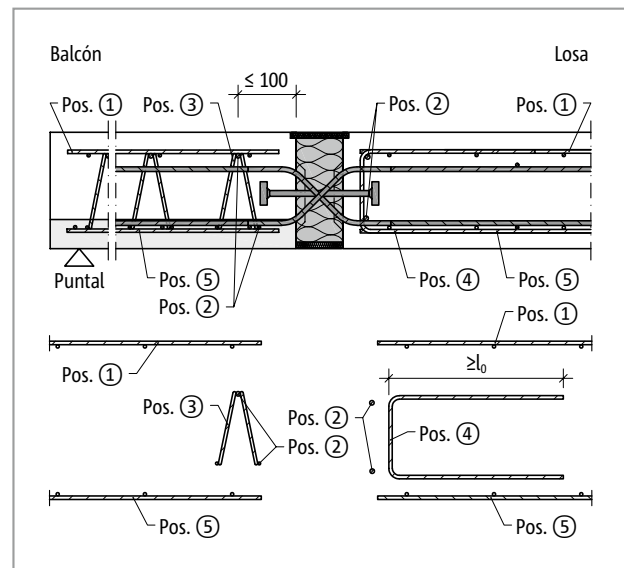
Schöck Isokorb® T tipo Q-P-VV: Armadura in situ, del lado del balcón con viga de celosía
